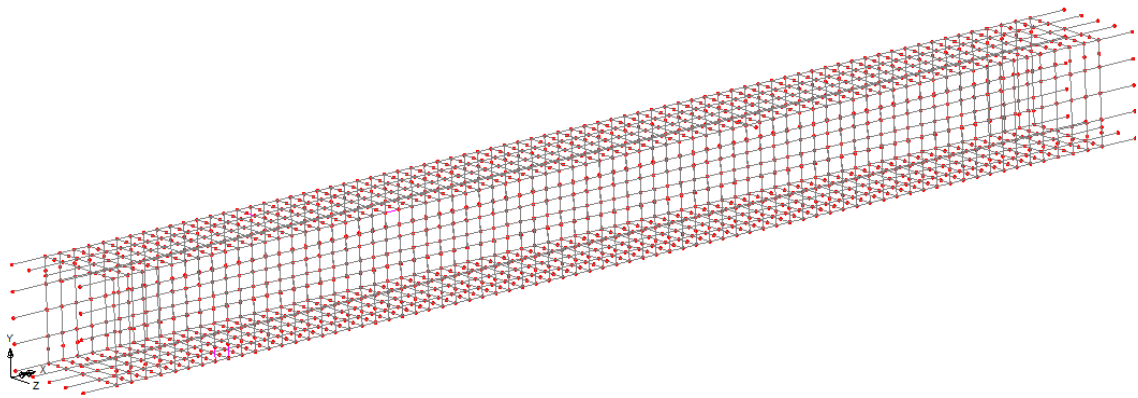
Malha de elementos finitos das armaduras de reforço, LUSAS
